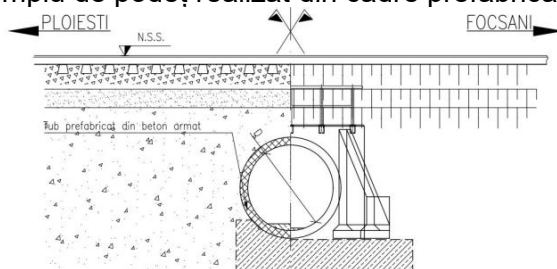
Exemplu de podeț realizat din tuburi prefabricate din beton armat
